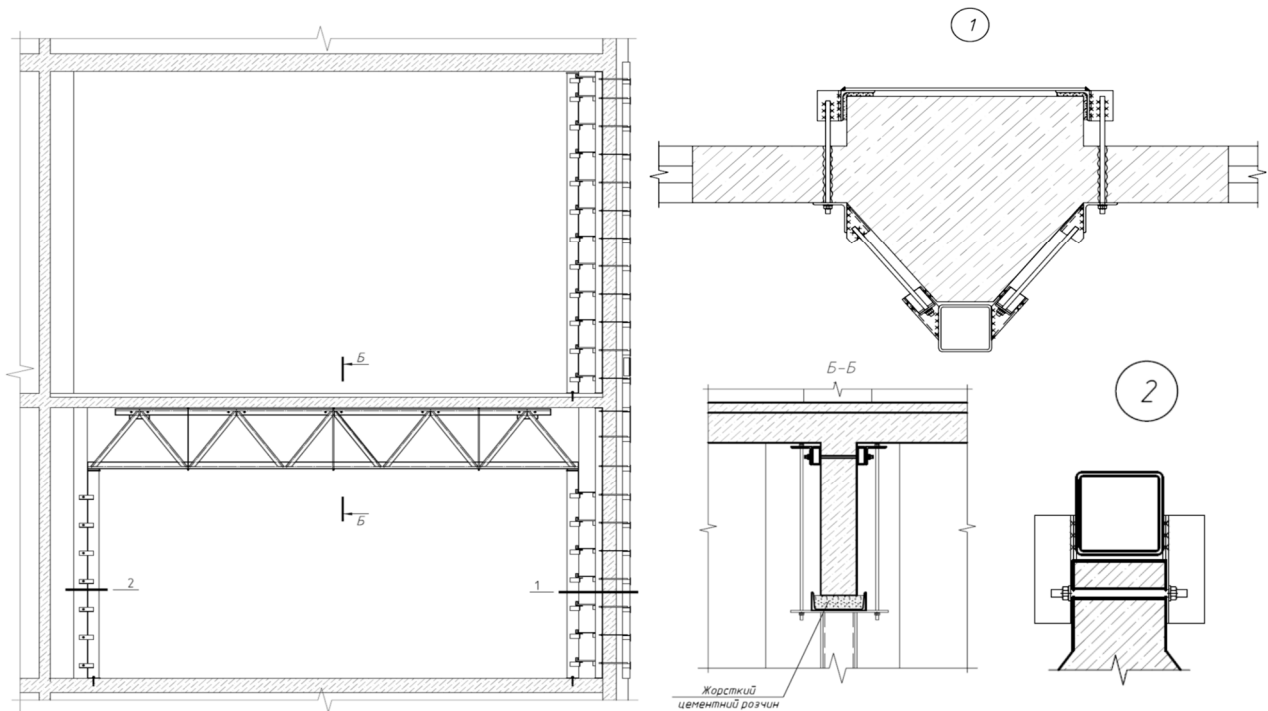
Схема підсилення пошкоджених конструкцій будівлі
